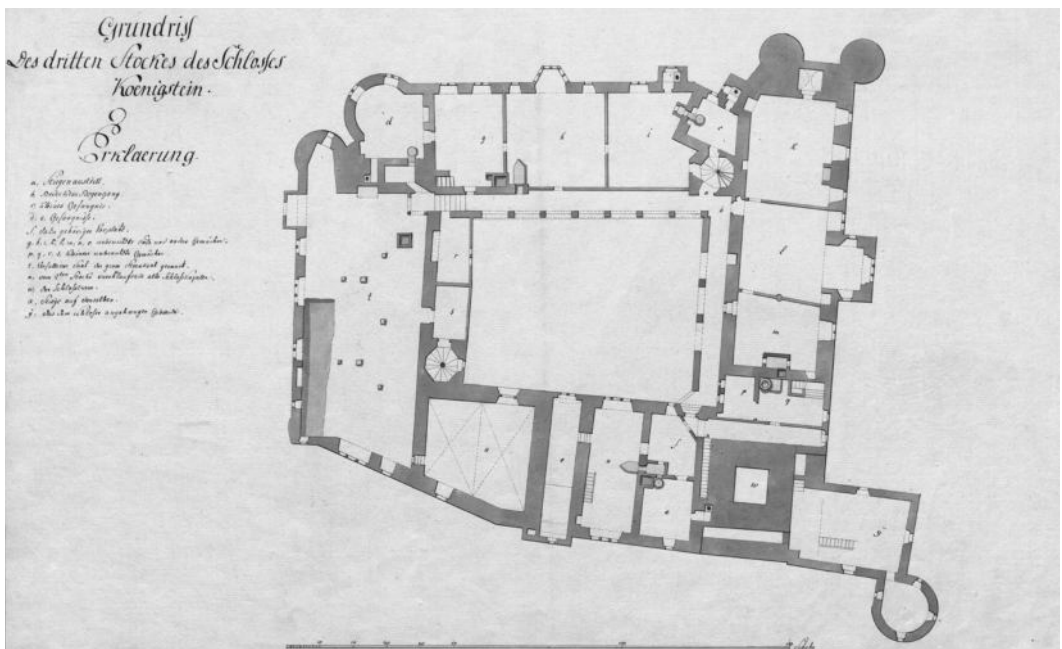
„Grundriss Des dritten Stockes des Schlosses Koenigstein“, Ingenieur-Oberleutnant Jean François Xavier Mangin, im Jahr 1790/1791.
